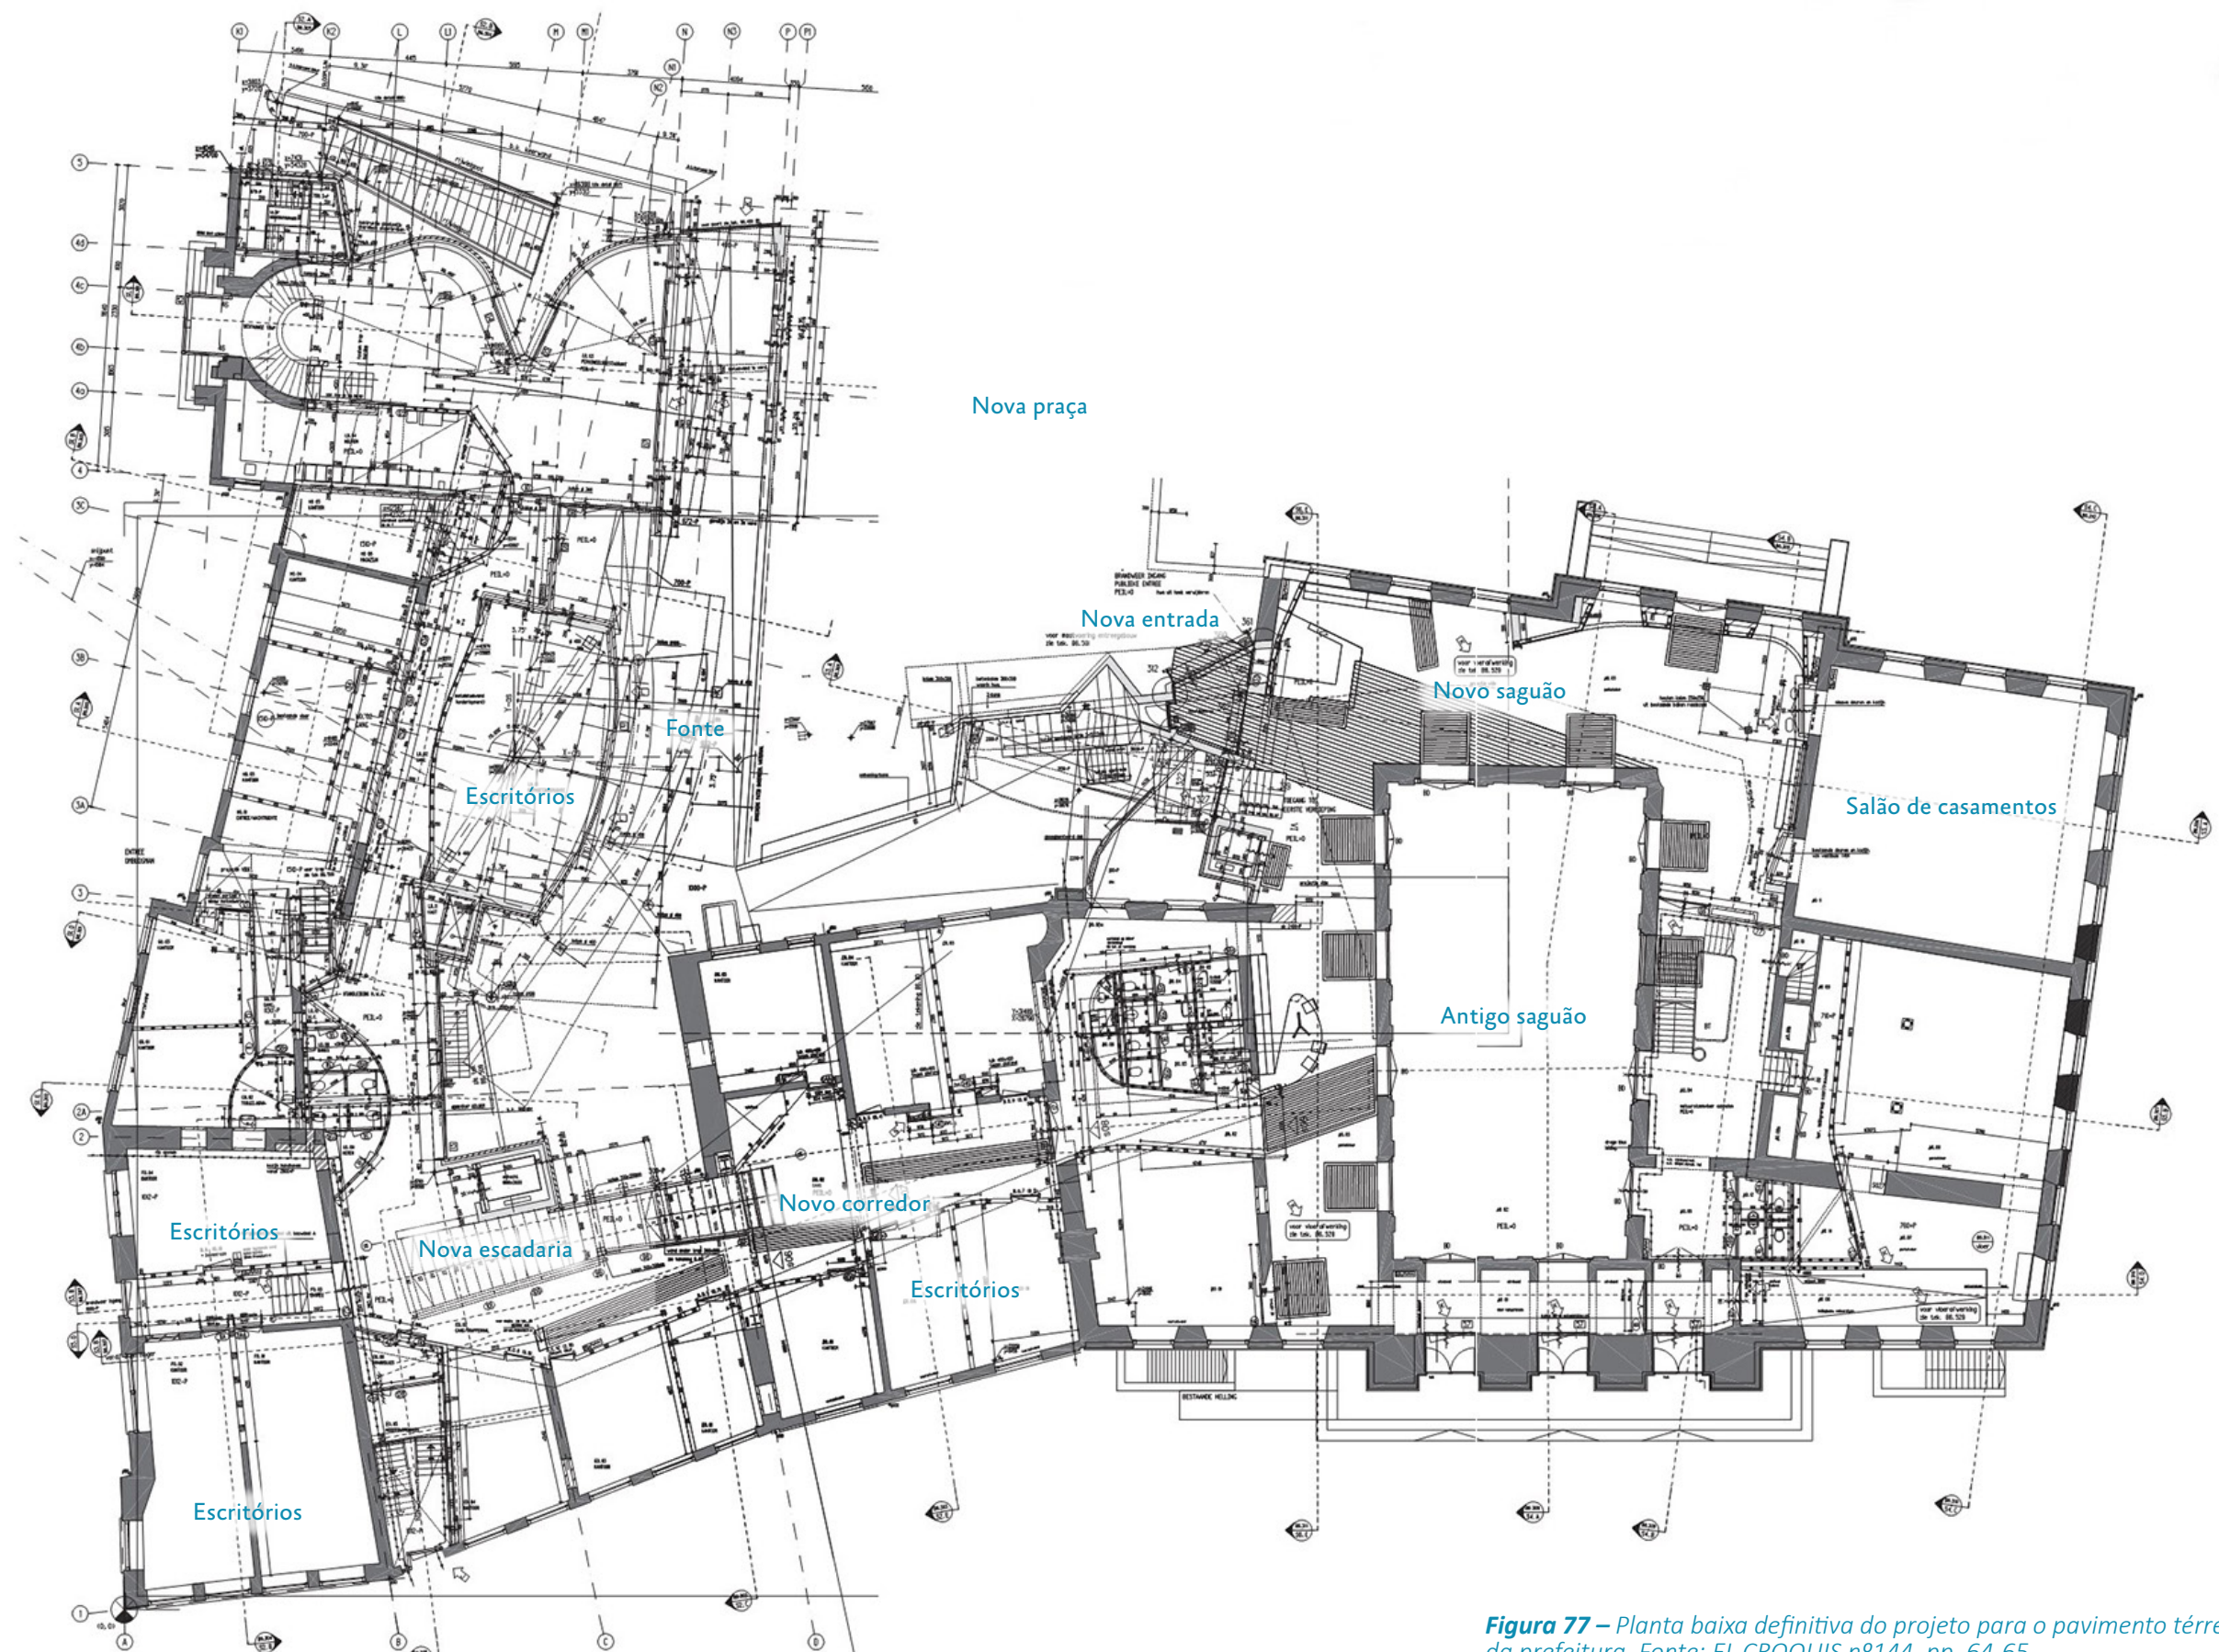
Planta baixa definitiva do projeto para o pavimento térreo da prefeitura. Fonte: EL CROQUIS nº144, pp. 64-65.
